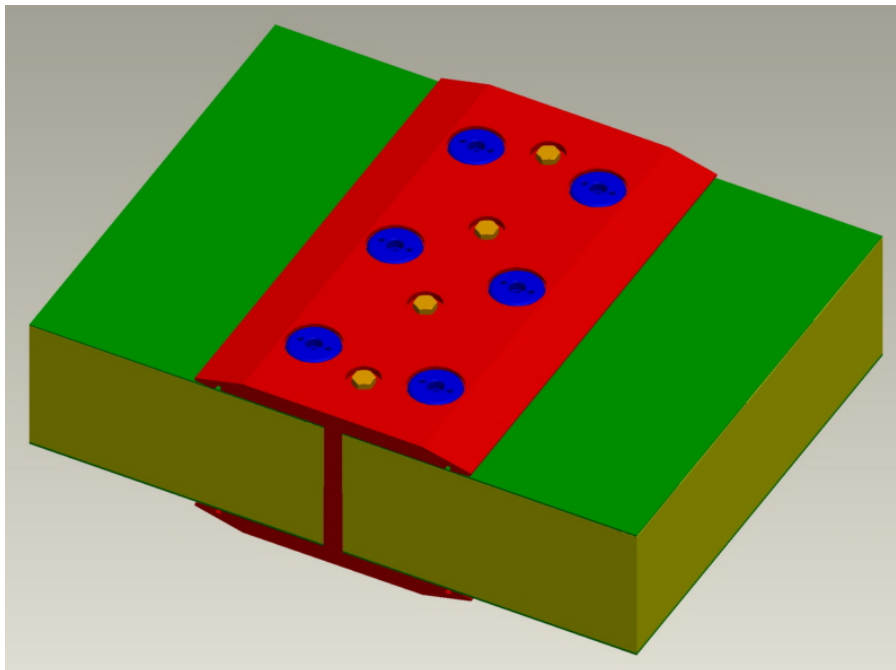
3D-Modell des SE-Schrauben-Verbinders in Pro/Engineer Wildfire
